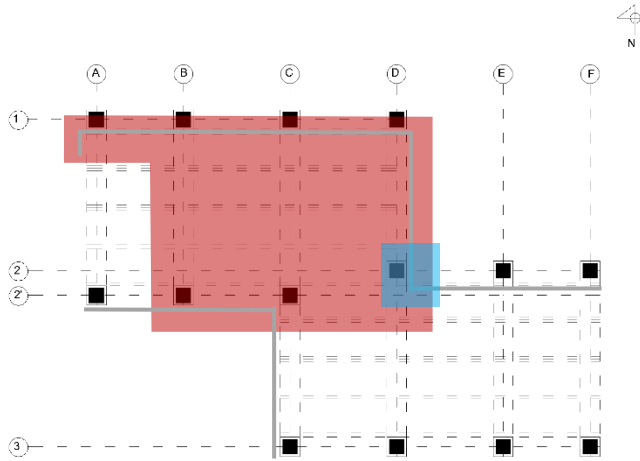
Planta estructural de palafito experimental, San Crisanto, Yucatán, México. Dibujado por Arq. Estrada
